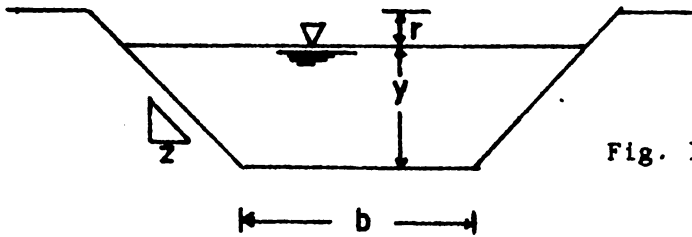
Schéma de la section transversale d'un canal trapézoïdal.
